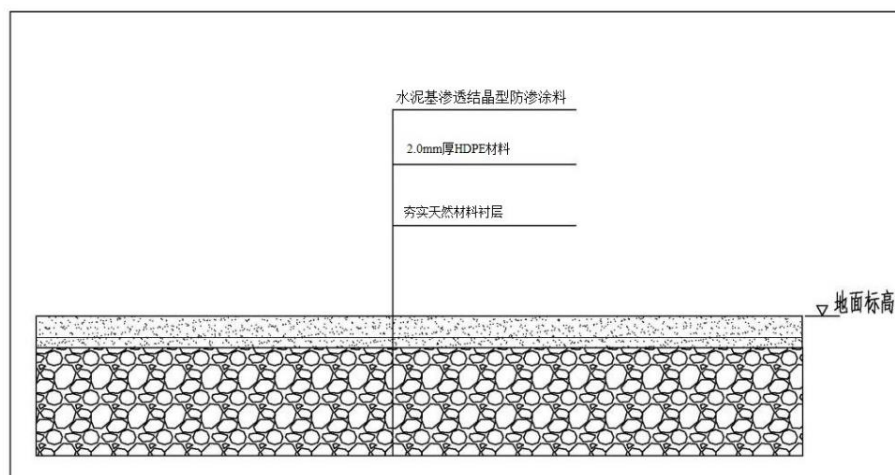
箱变、主变事故油池重点防渗示意图（剖面图）
